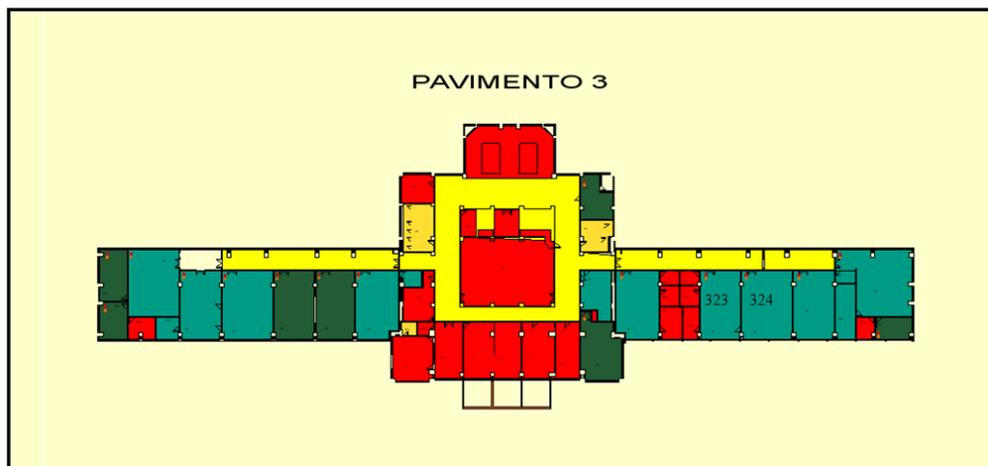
Planta baixa do 3º andar do Pavilhão Reitor Haroldo Lisboa da Cunha
